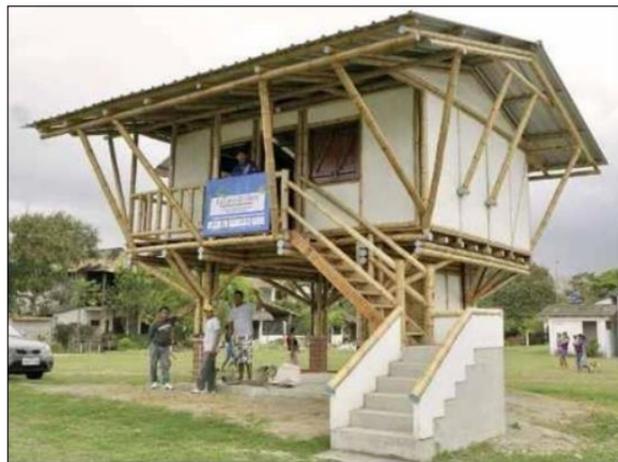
Casa elevada de caña guadua – Olón /Santa Elena
